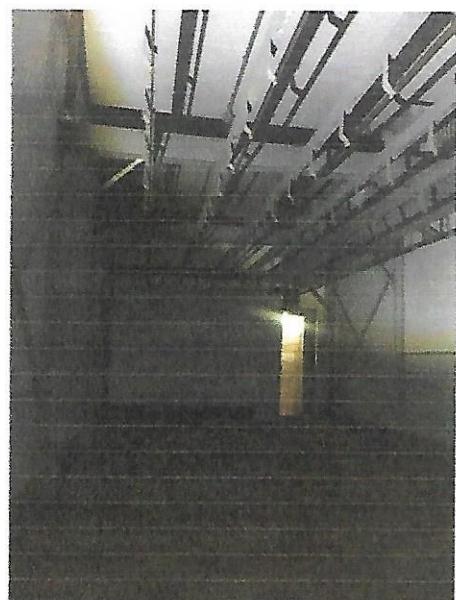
Câmara de Estocagem de Carcaça 01 (Foto Interna)
